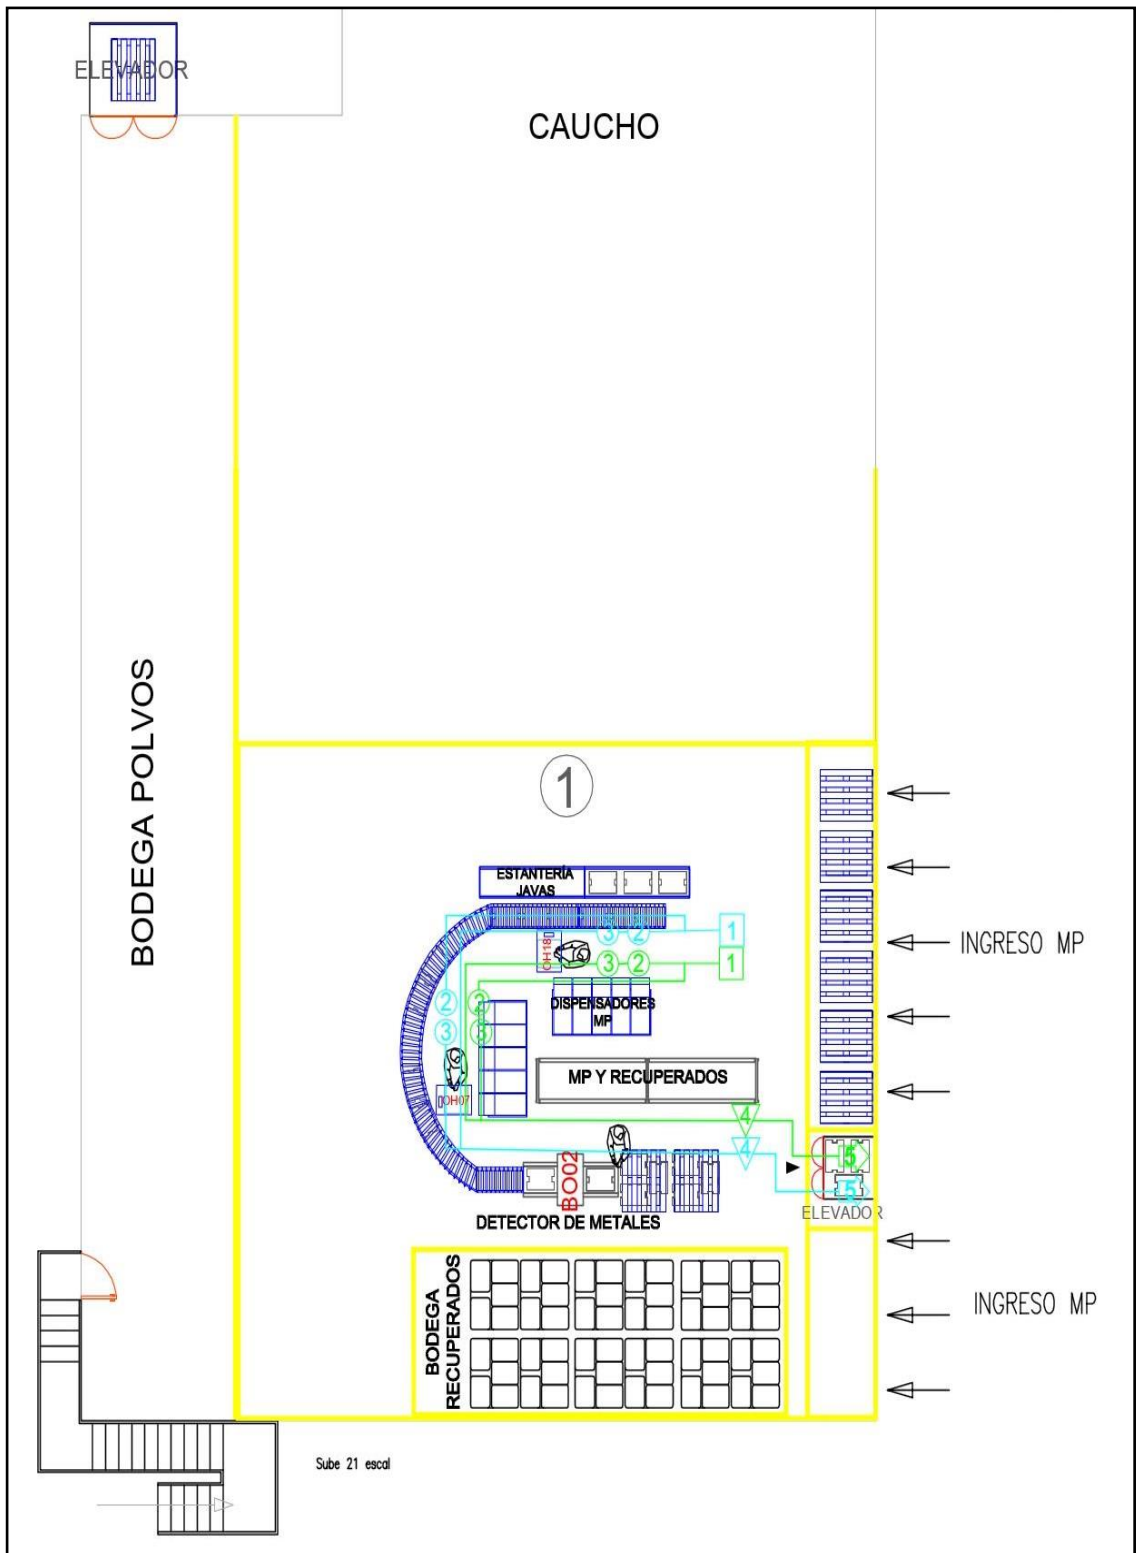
Construcción del Layout en AutoCAD (Planta Alta)
